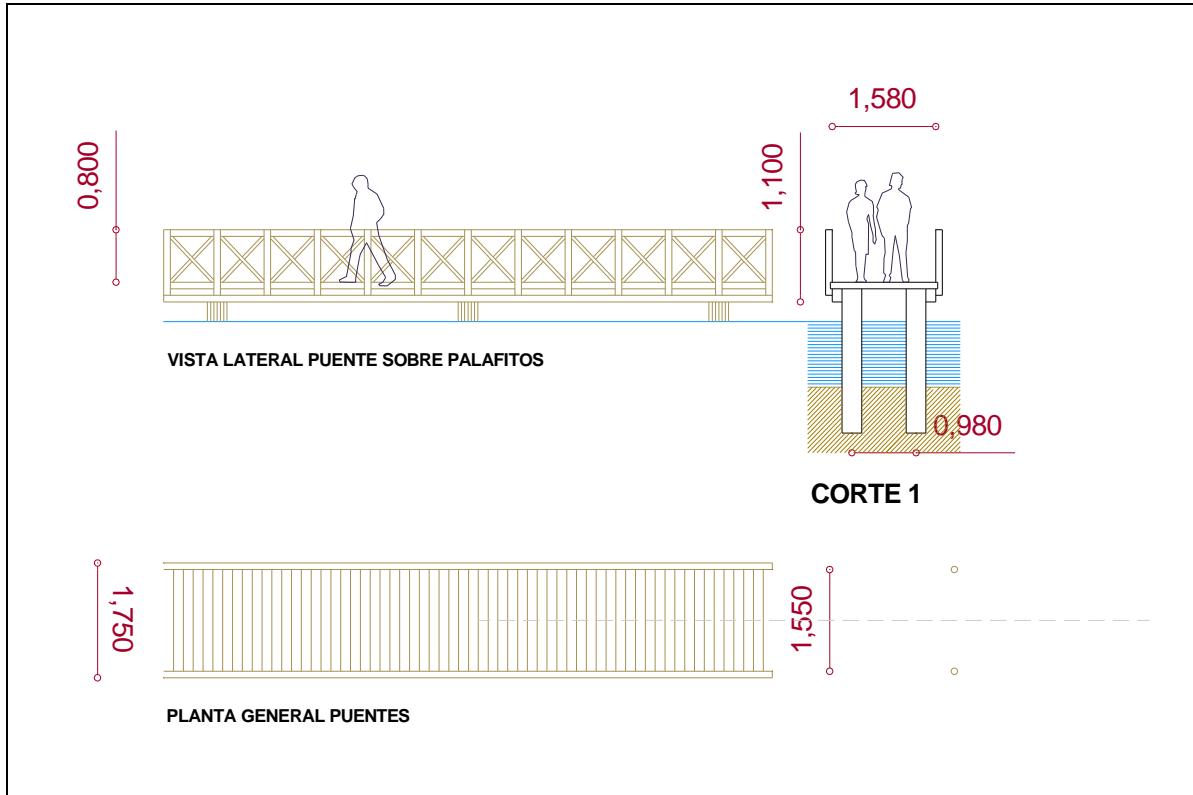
SENDERO ELEVADO SOBRE PALAFITOS
